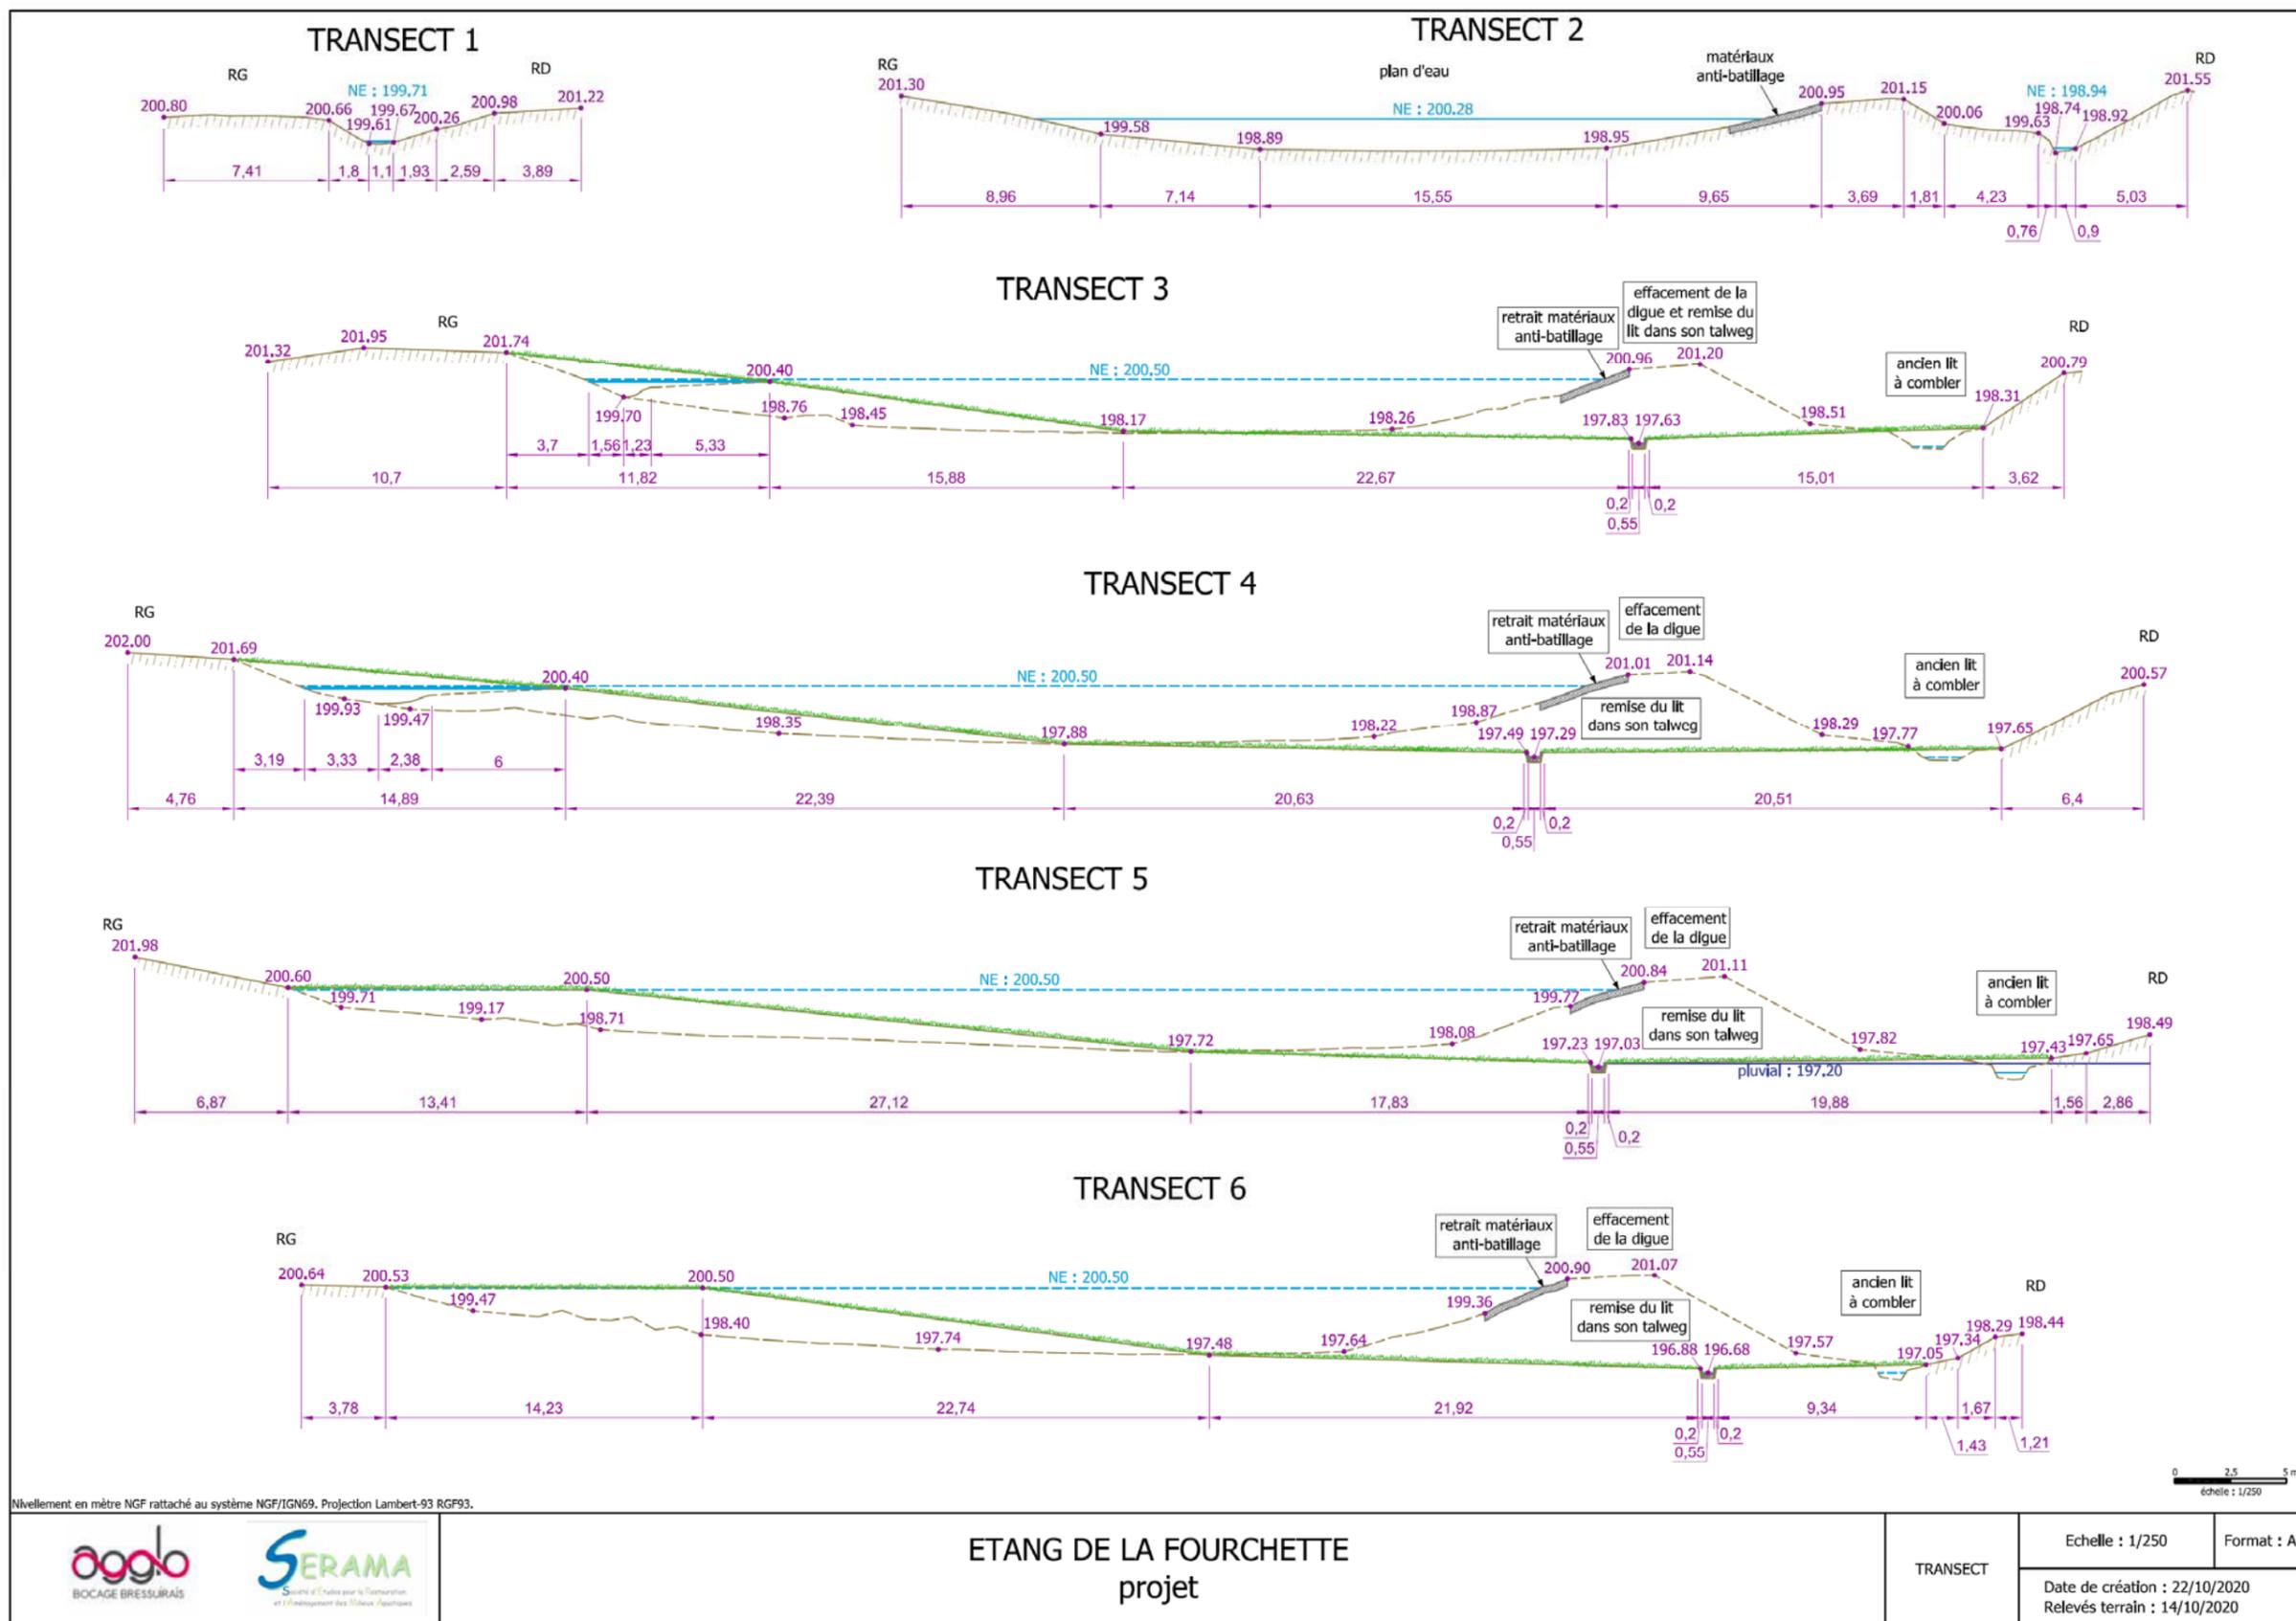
Profils en travers de projet sur le site du plan d'eau de la Fourchette
